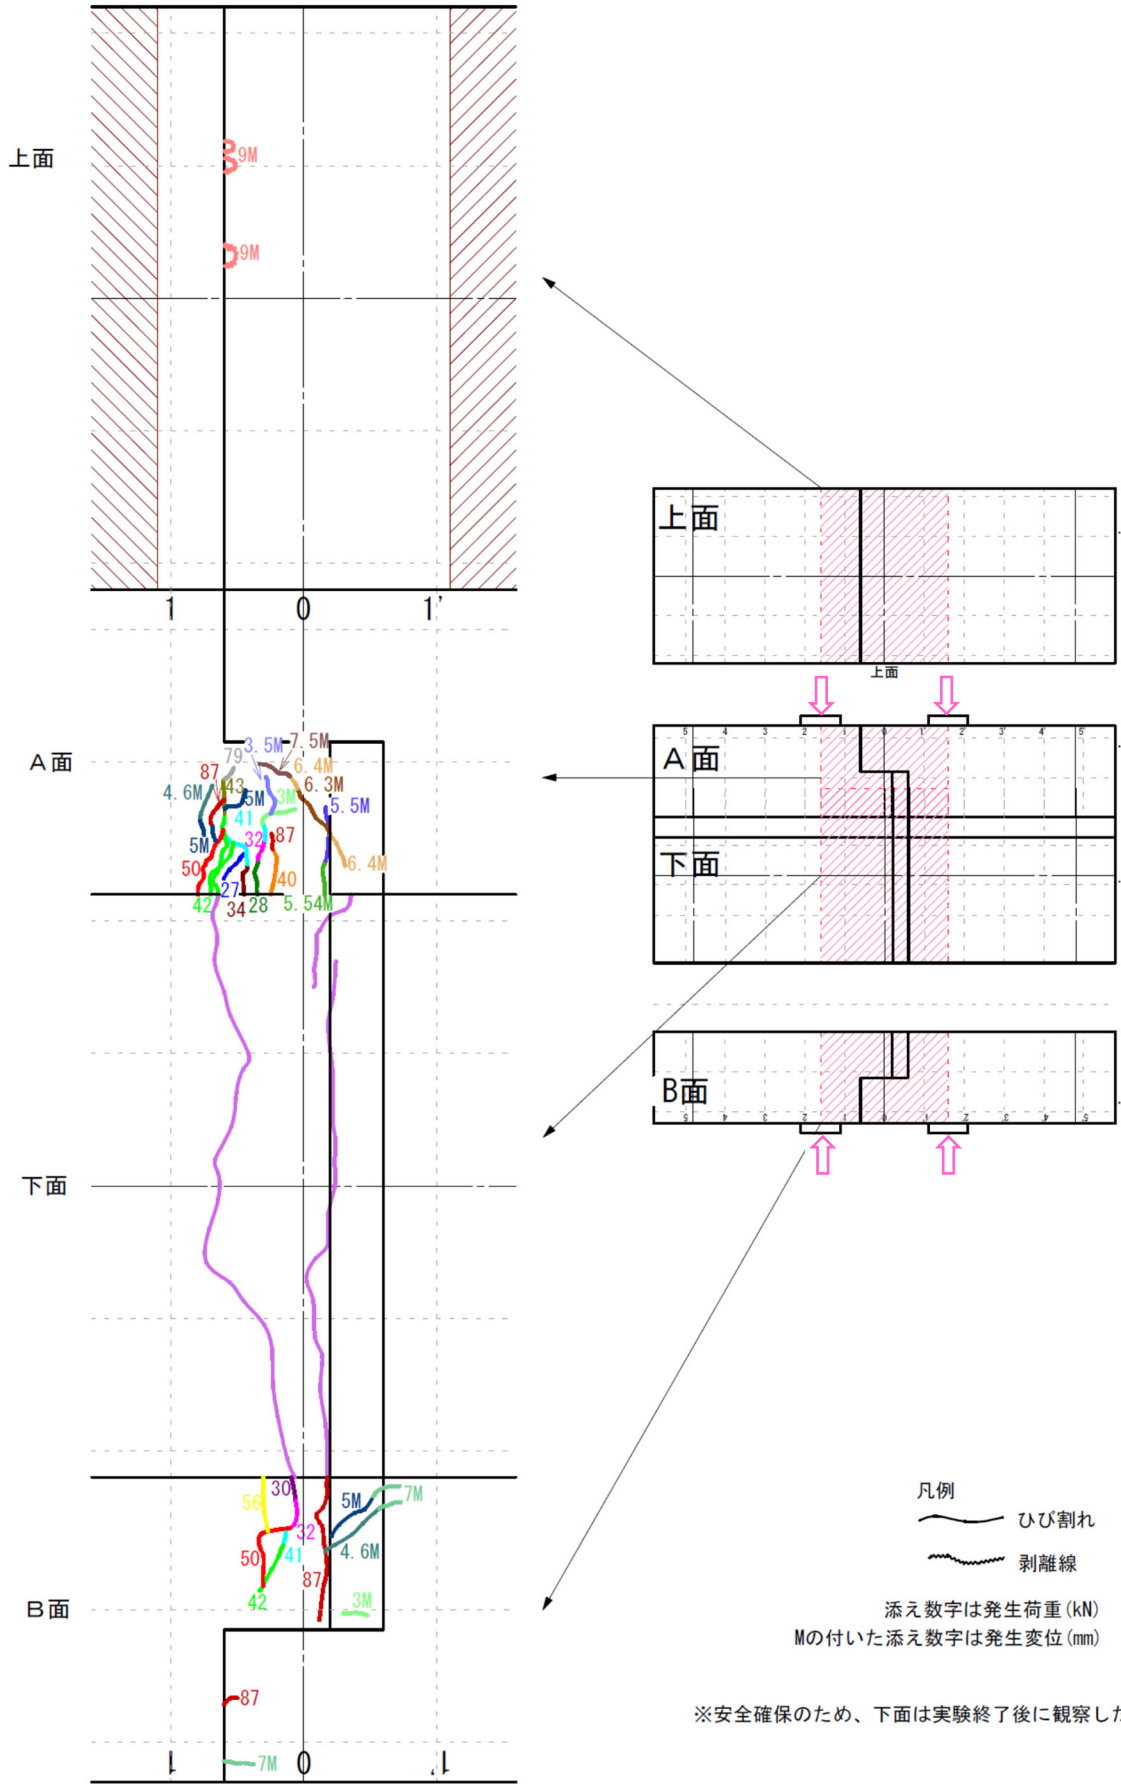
ひび割れ図 (供試体 KF1-3)
